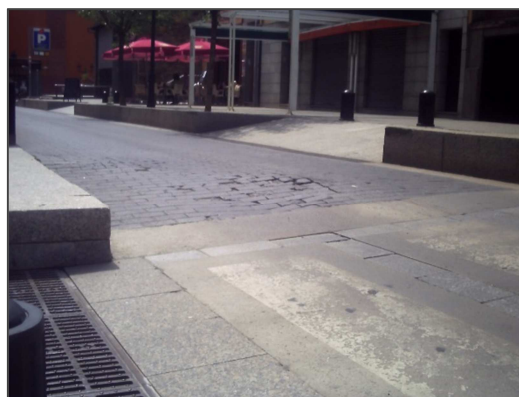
Estado del pavimento en rda. Josep M^a Martí. [Fuente: J. Espejo]
